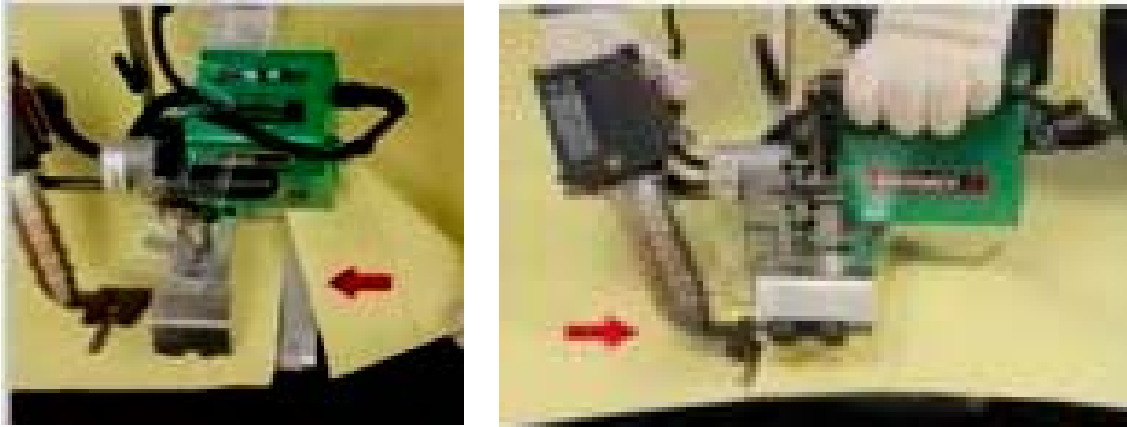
Сварка напусков рулонного слоя «Термоплита»
